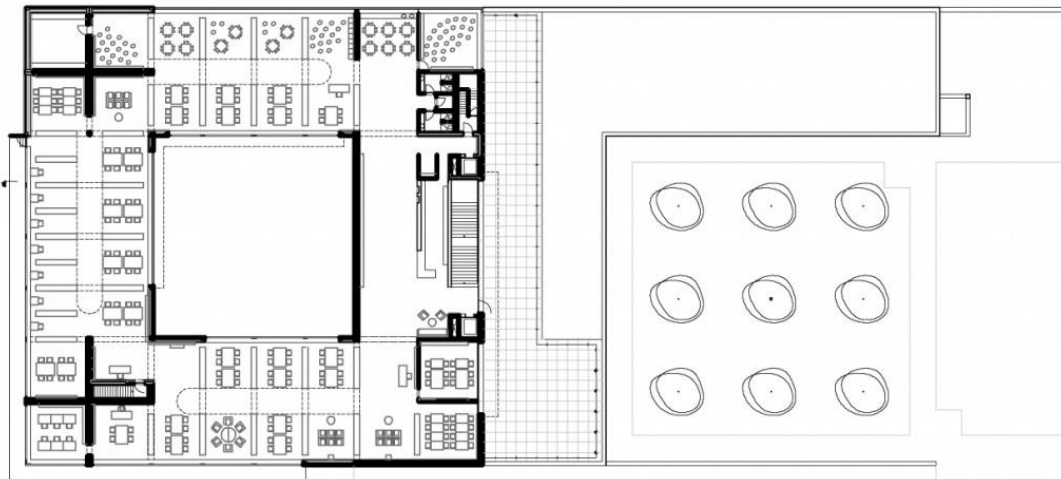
Primera Planta Alta, Biblioteca Viana Do Castelo
